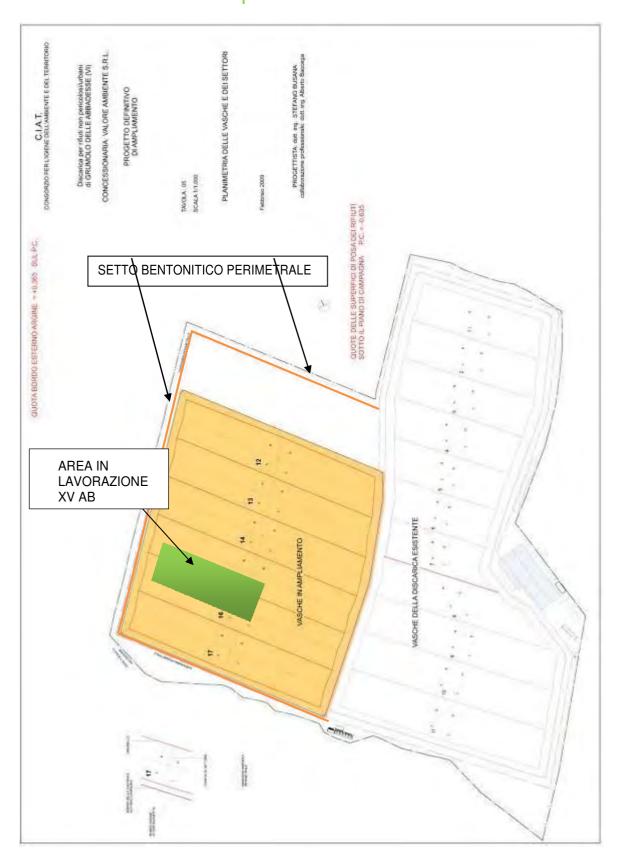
planimetria dello stato di avanzamento lavori di approntamento vasche
